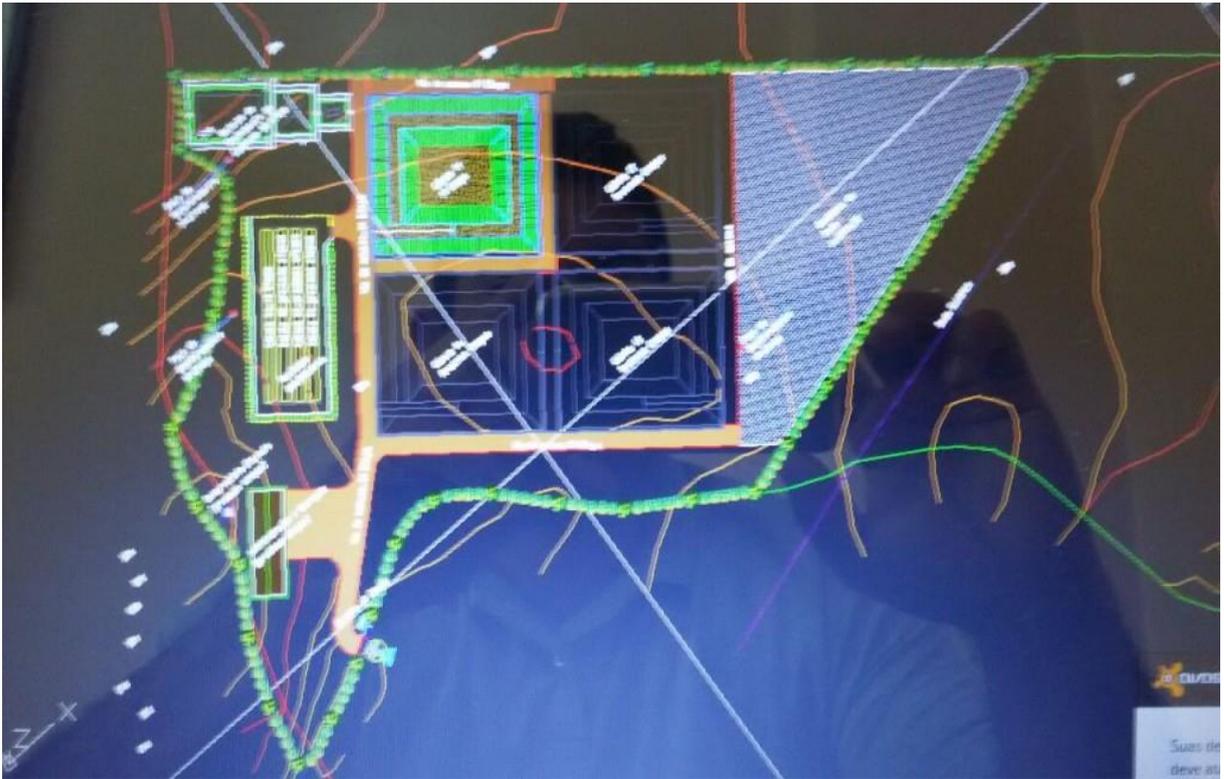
Planta baixa do aterro sanitário de Dona Inês/PB.
